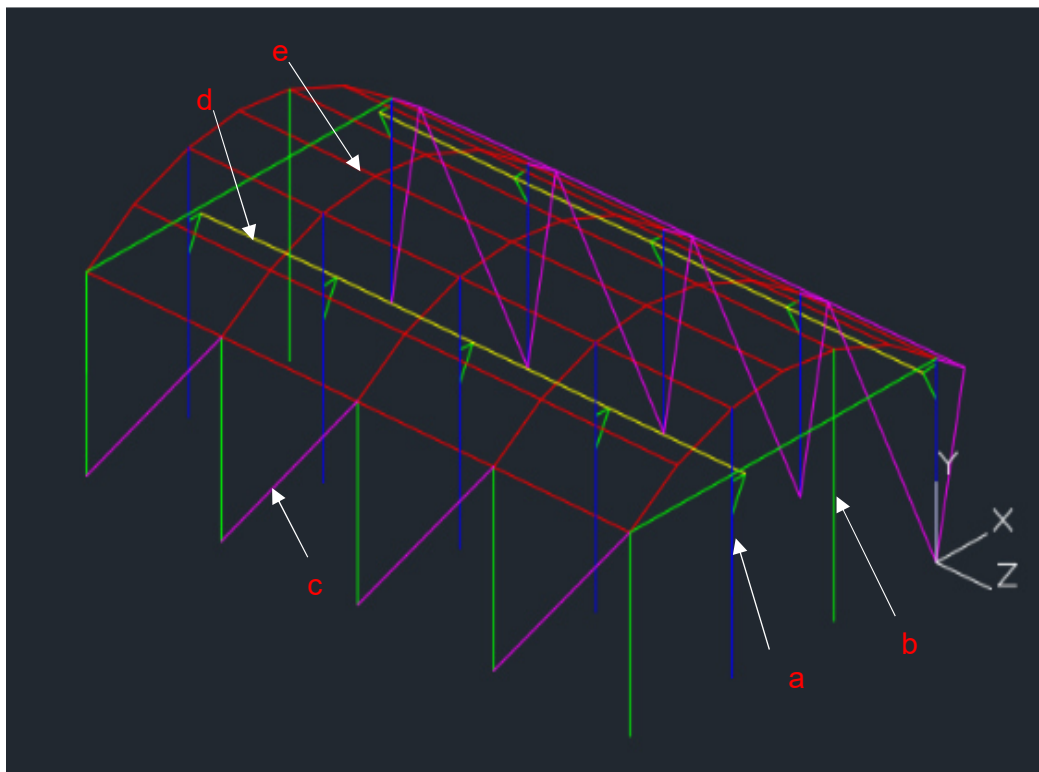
Diagrama unifilar de la estructura metálica del galpón diseñado en AutoCAD.
